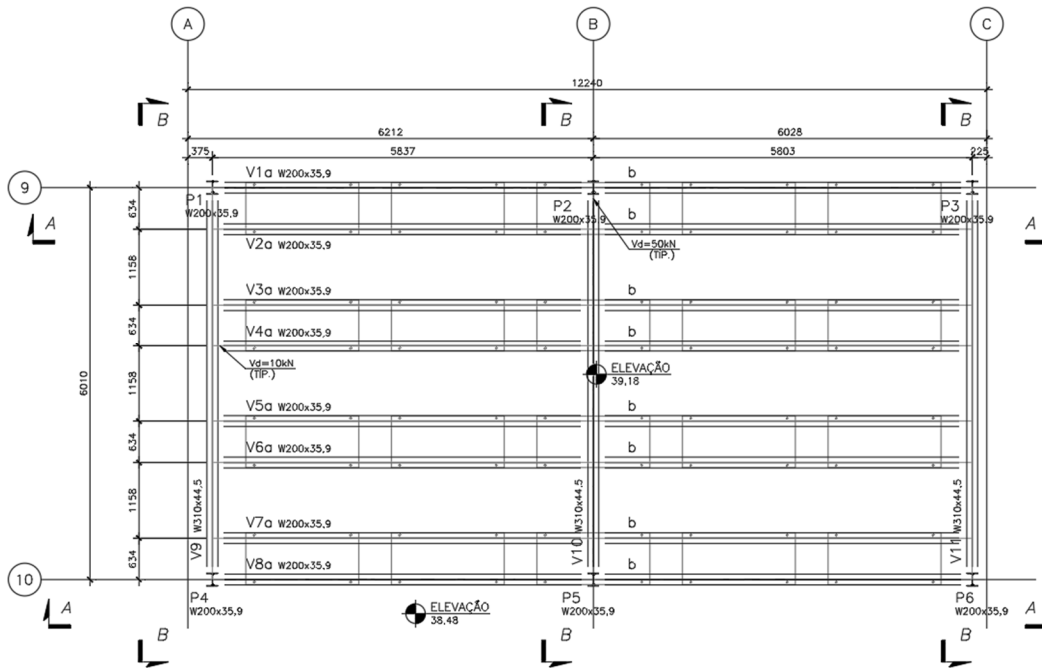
Planta do pórtico a ser instalado sobre a região à esquerda da edificação.
